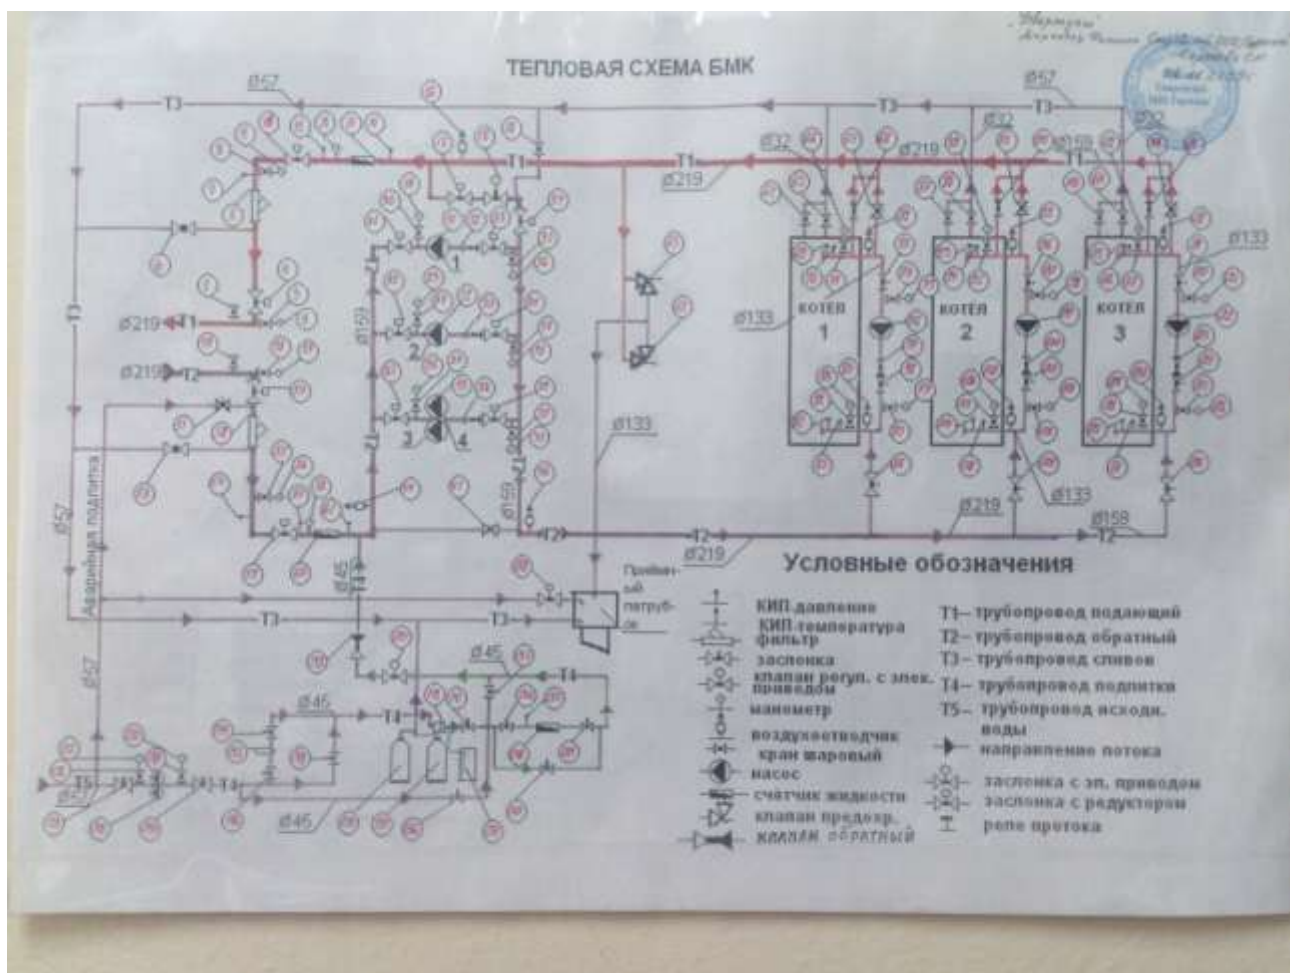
Тепловая схема котельной БМК
